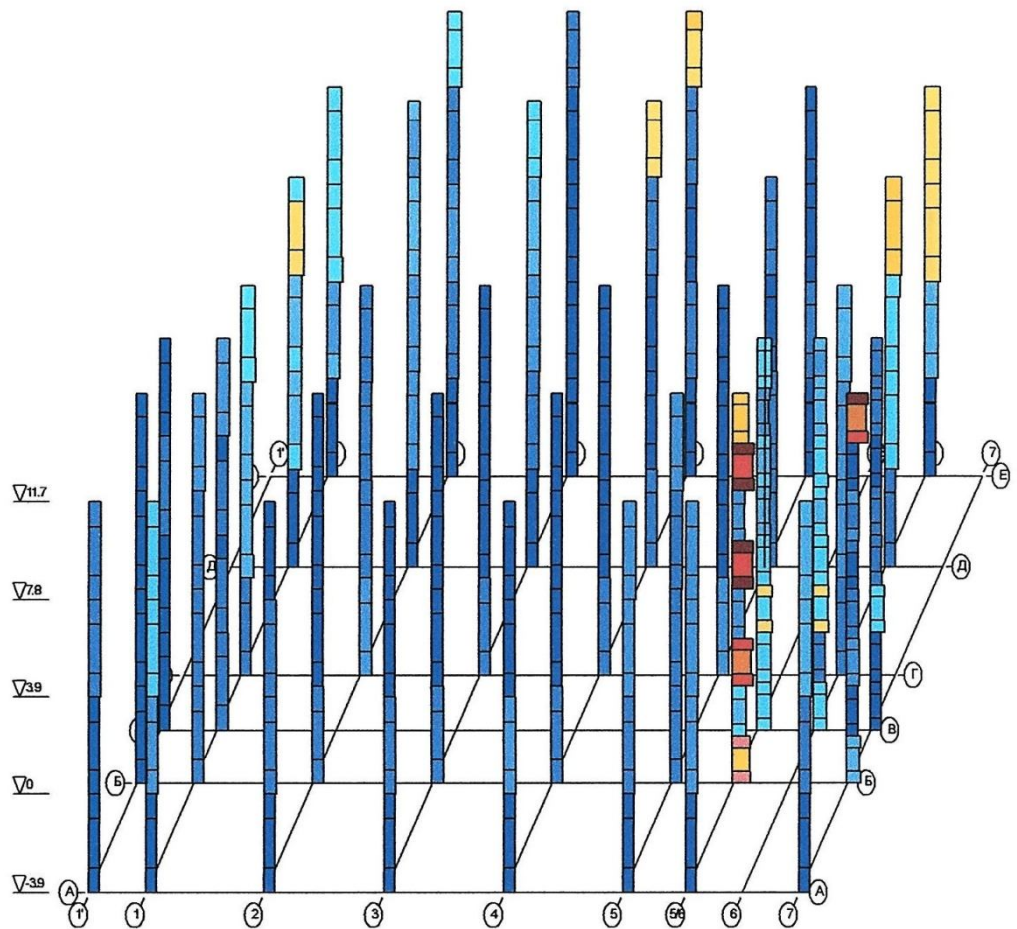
Необхідні площі поздовжньої арматури у колонах перетином,
